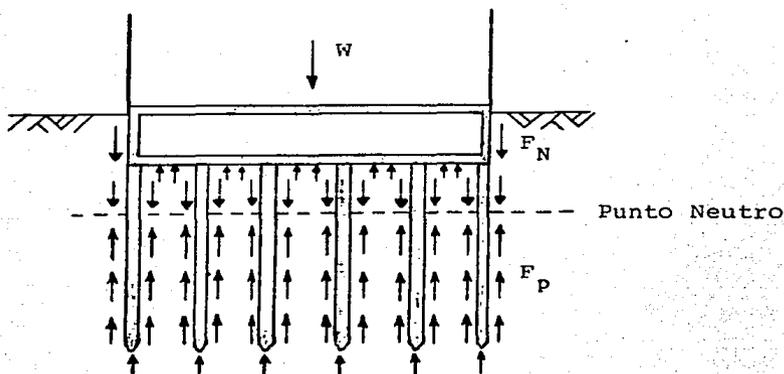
CAJON CON PILOTES DE FRICCION.
